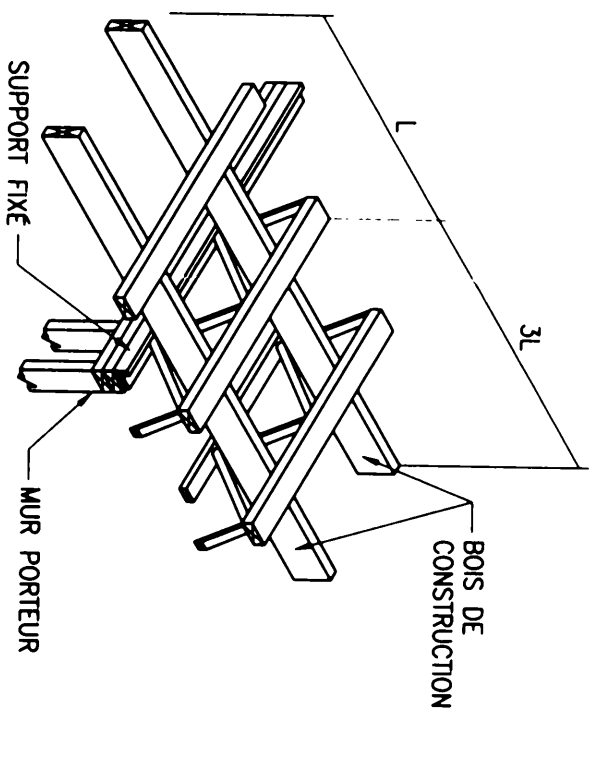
DETAIL TYPIQUE ATTACHE SOLIVE A UNE POUTRE
